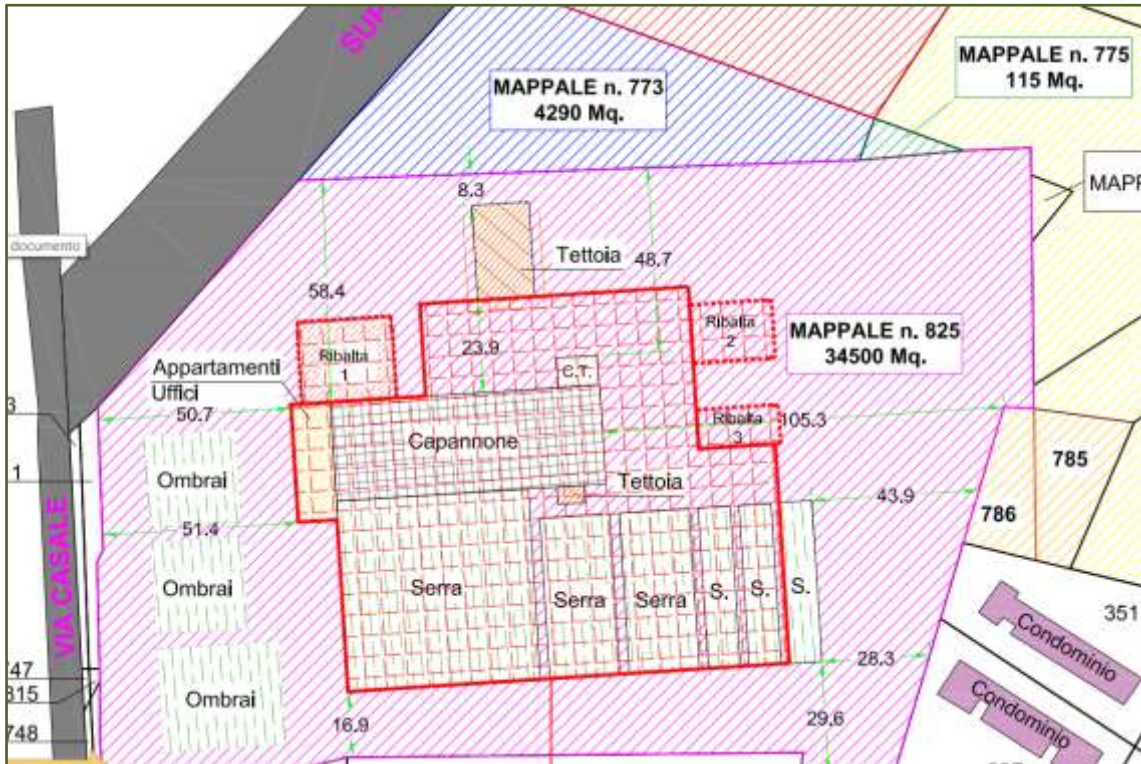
Planimetria generale (in rosso l'edificio di progetto)
